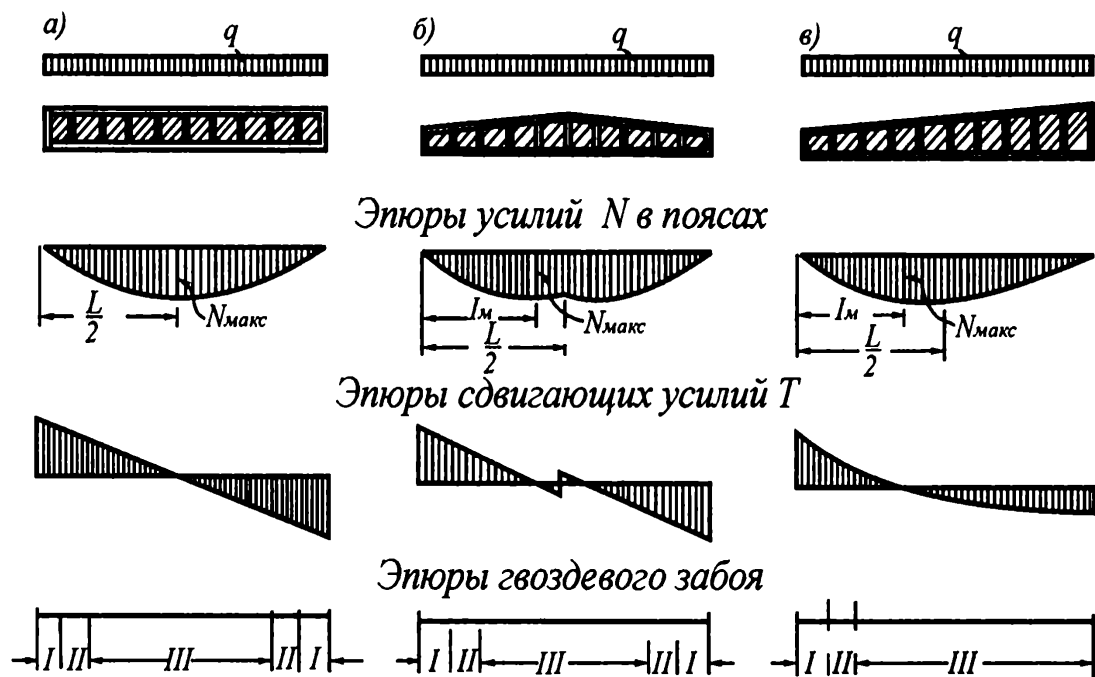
Эпюры нормальных и сдвигающих усилий и зоны гвоздевого забоя в балках с перекрестной стенкой: а) - балка с параллельными поясами; б) - двускатная балка; в) - односкатная балка
